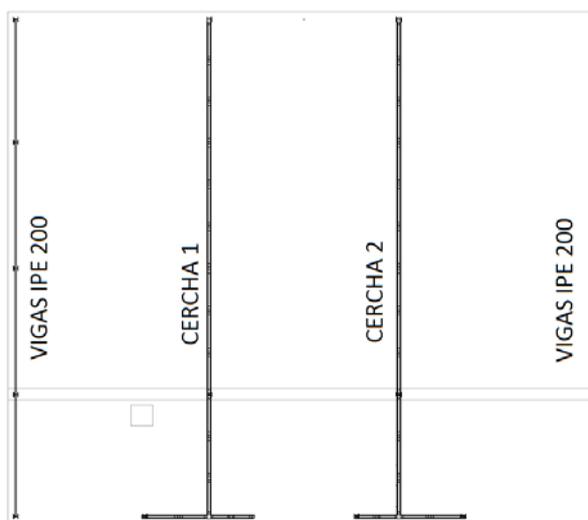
Esquema de localización de cerchas y vigas en Planta Primera. (Elaboración propia, Allplan).
